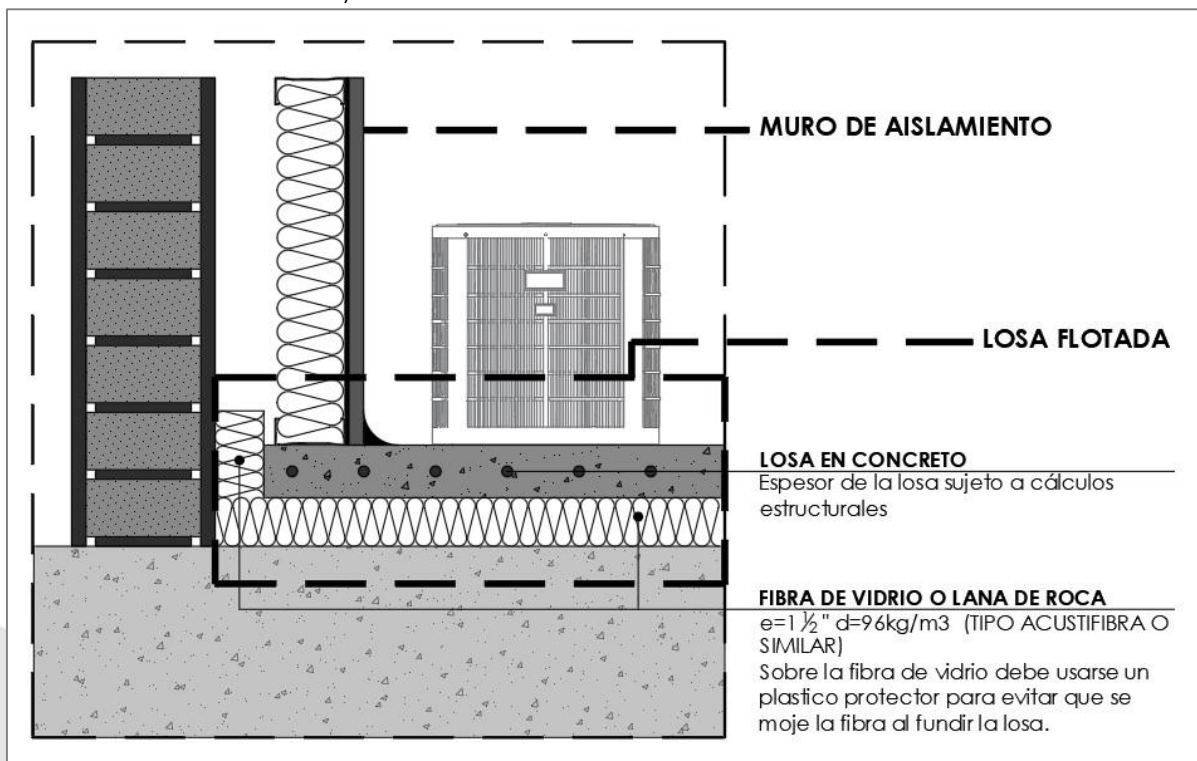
Ejemplo. Detalle de implementación de sistemas de aislamiento en salas de máquinas.
